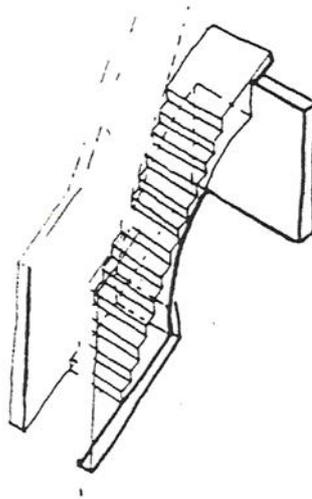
Exemplo de uma escada construir por tijolos de adobe [11]
